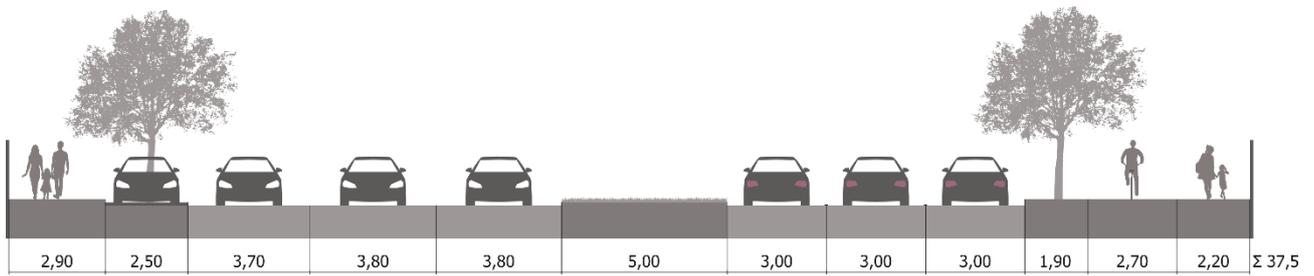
Regelquerschnitt 13, Lassallestraße Streckenbereich, Bestand und Planung
